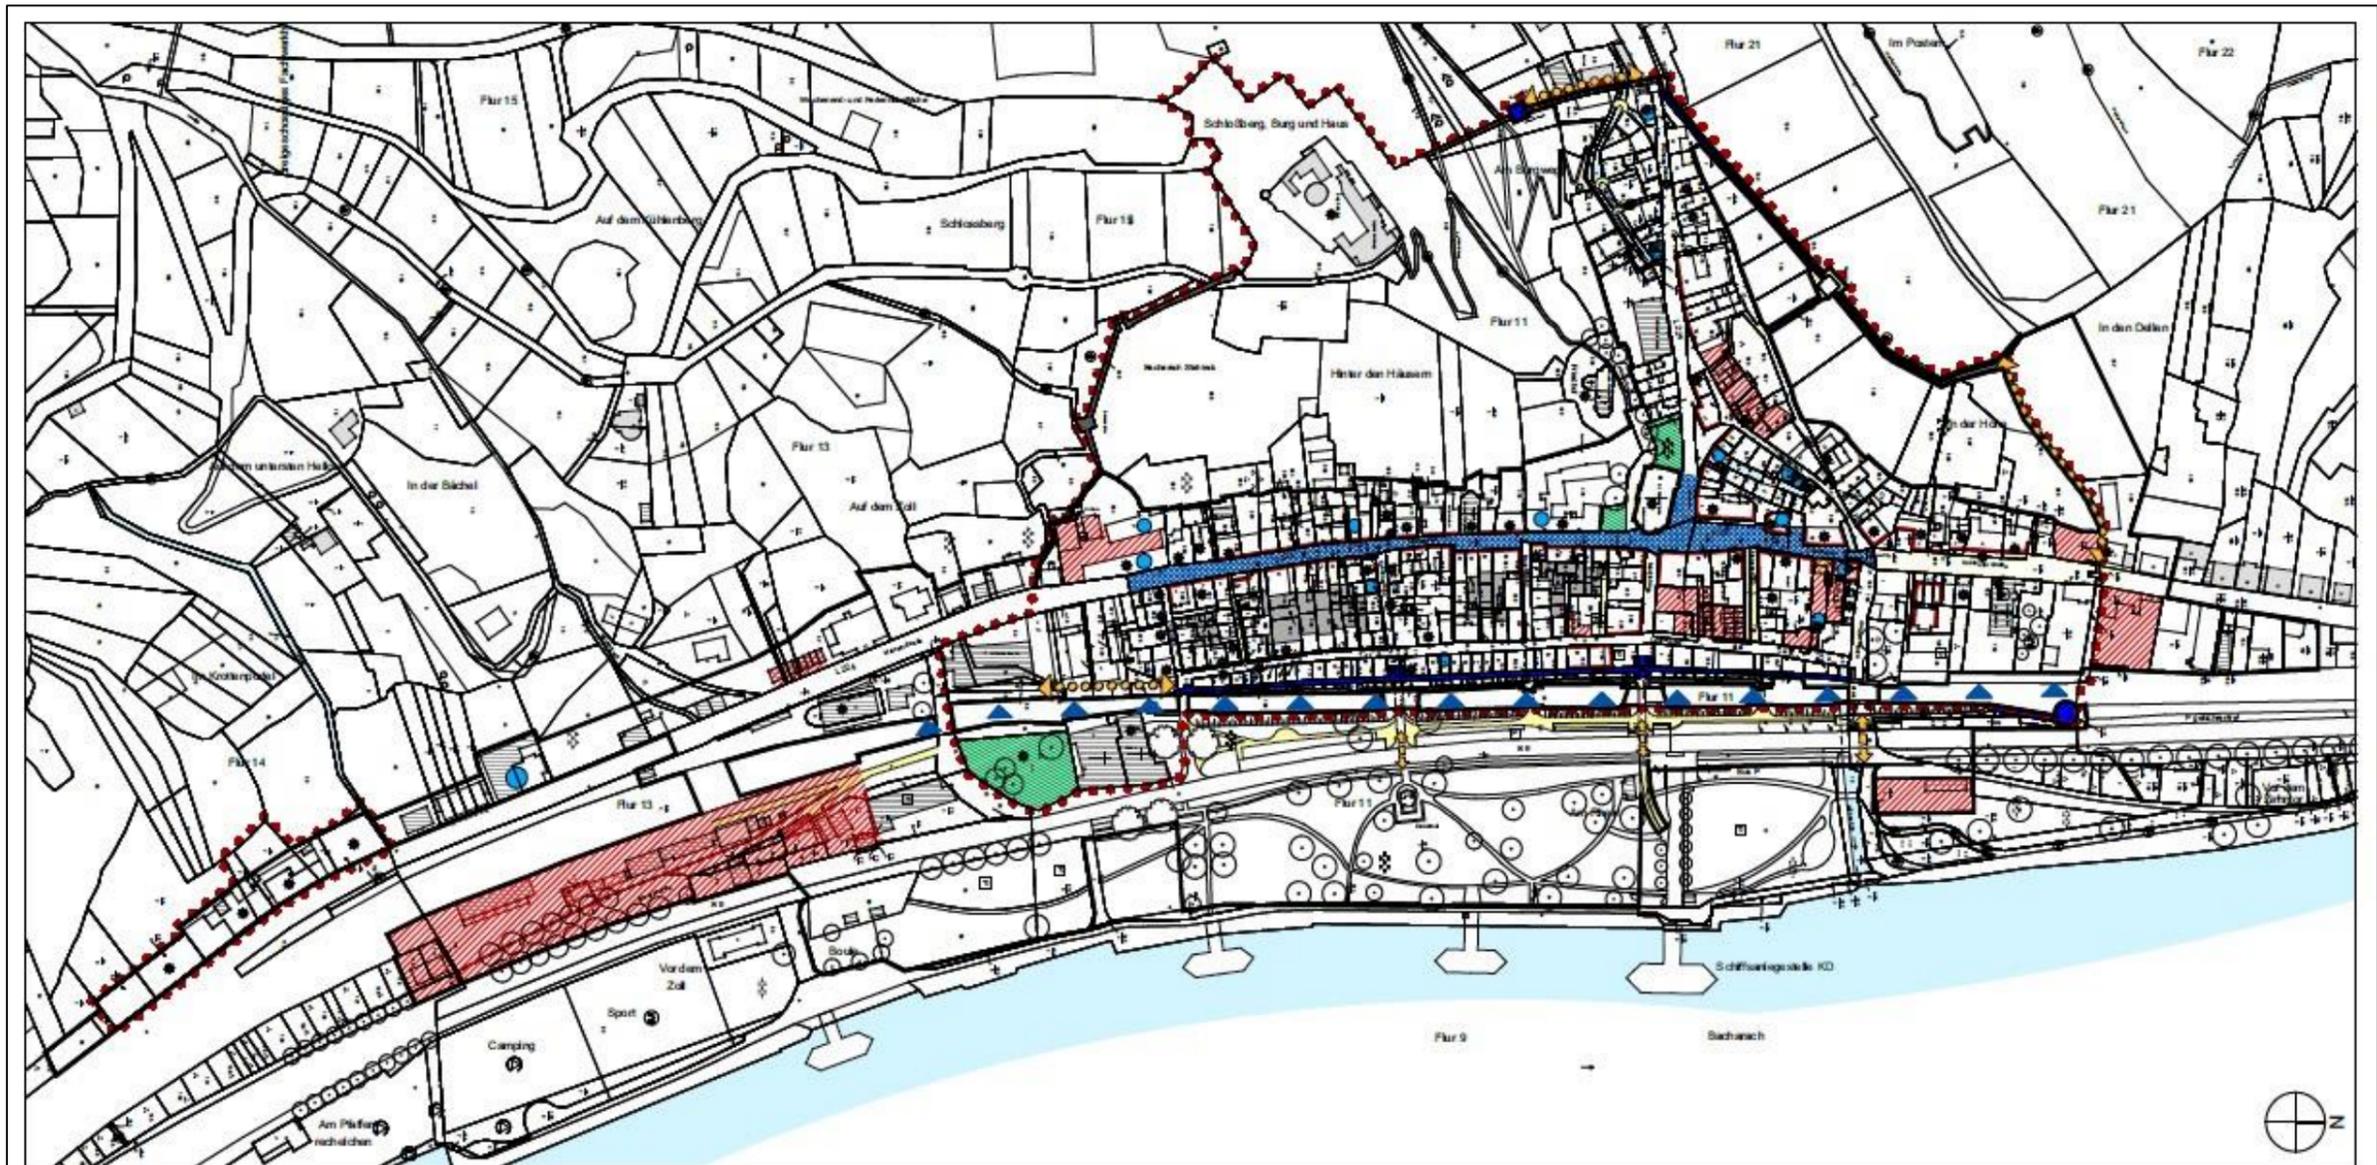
geplante gestalterische Einbindung der Hochwasserschutzmauer
